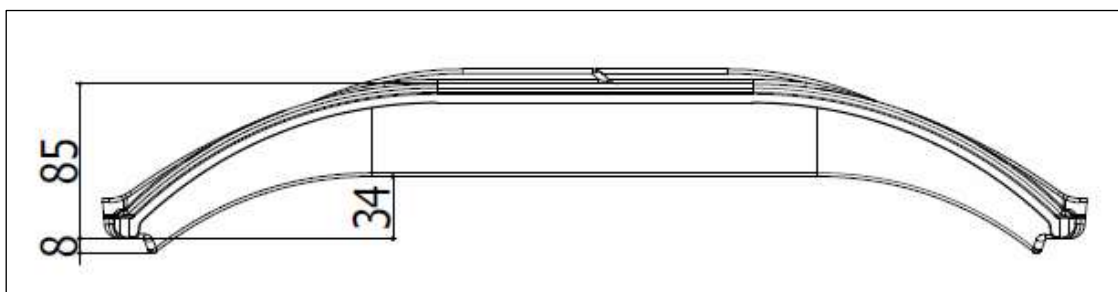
Prescriptions de forme entrevous Neobois et poutrelles DF
